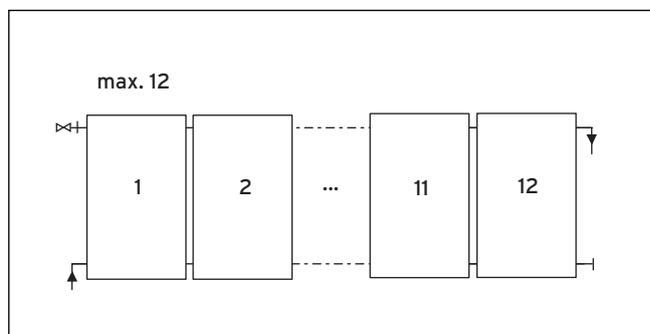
Disposizione adiacente del campo per 6 - 12 collettori
